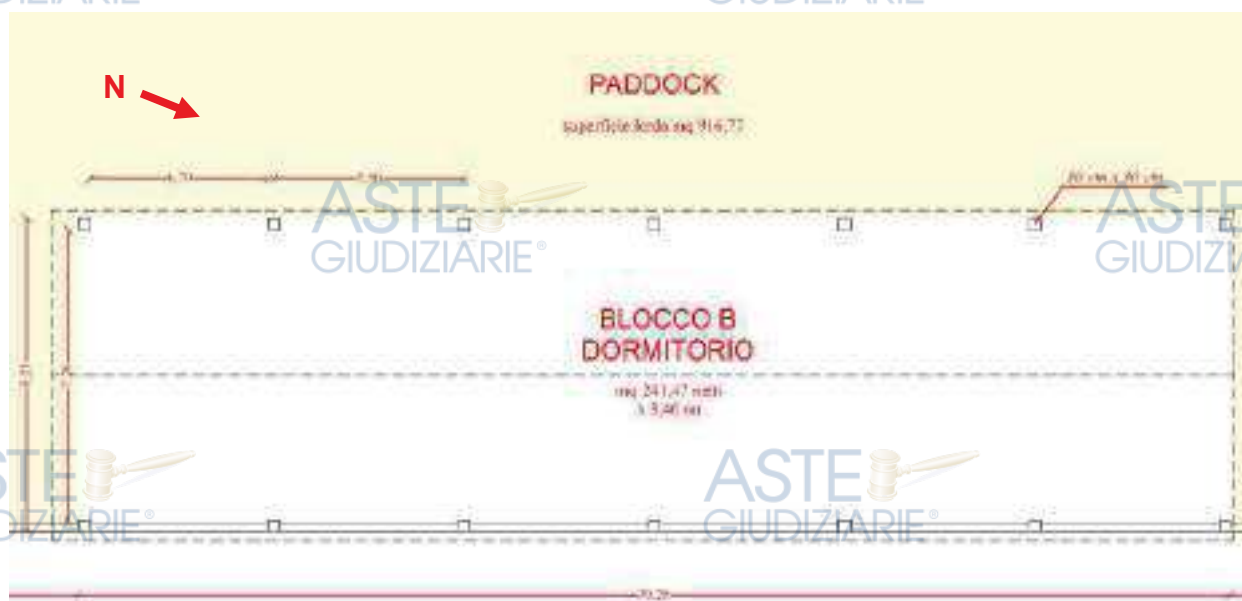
Blocco B, planimetria di rilievo (fuori scala)
